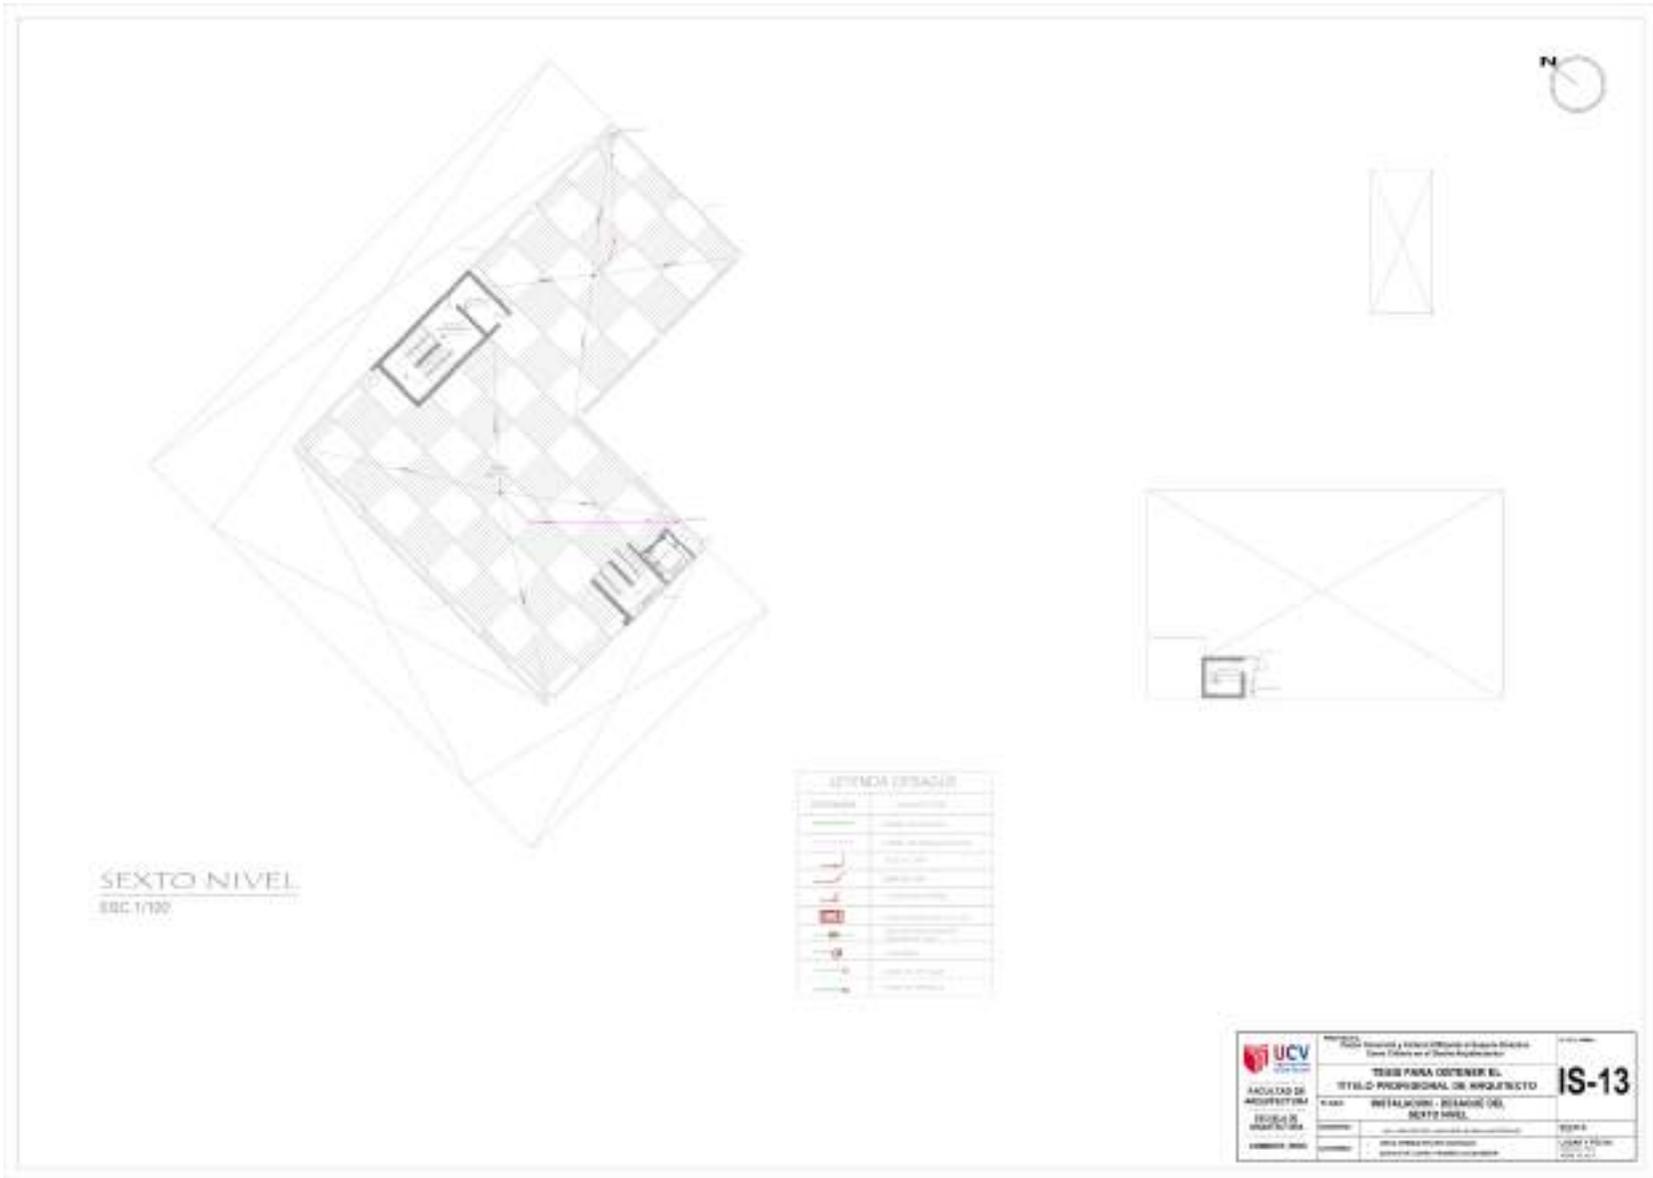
Plano de instalación de desagüe y pluvial sexto piso
